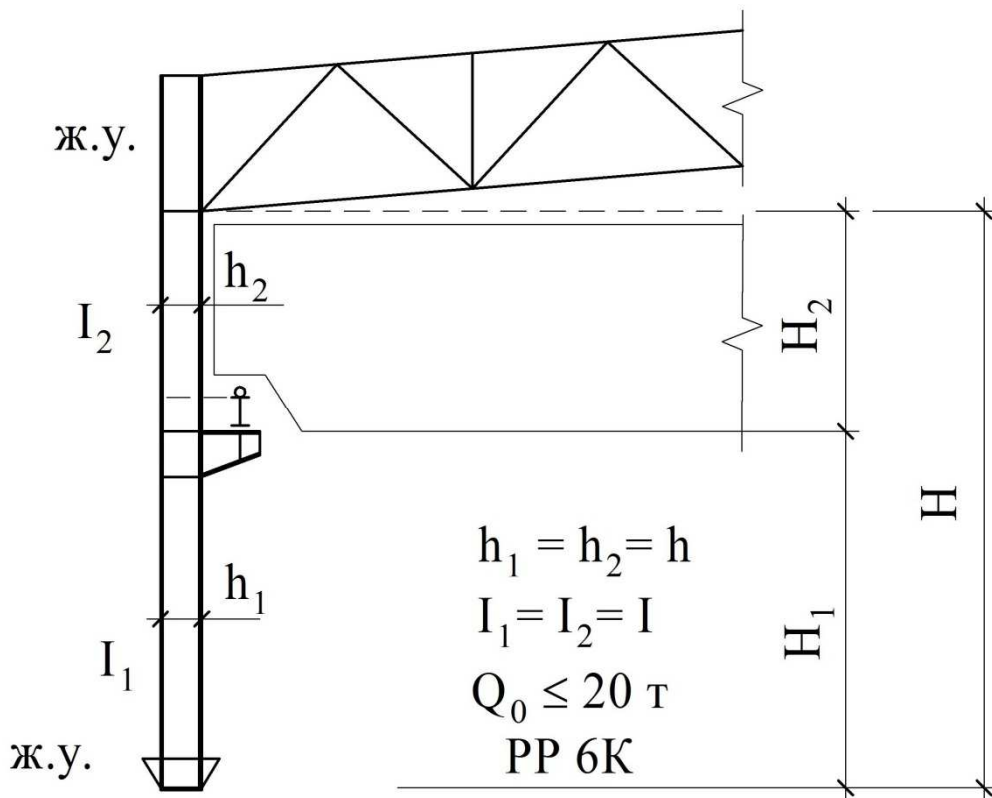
, б – Конструктивная схема однопролетной поперечной рамы с колоннами постоянного сечения (верхние и нижние узлы - жесткие)
